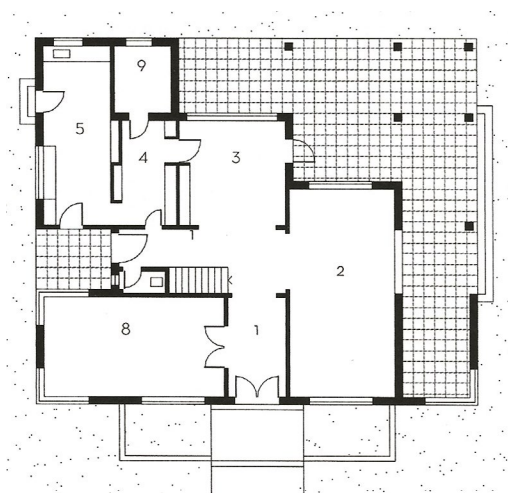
Configuração inicial. Planta baixa do pavimento térreo. Distribuição livre e assimétrica, varanda em L, janelas de canto.⁶
